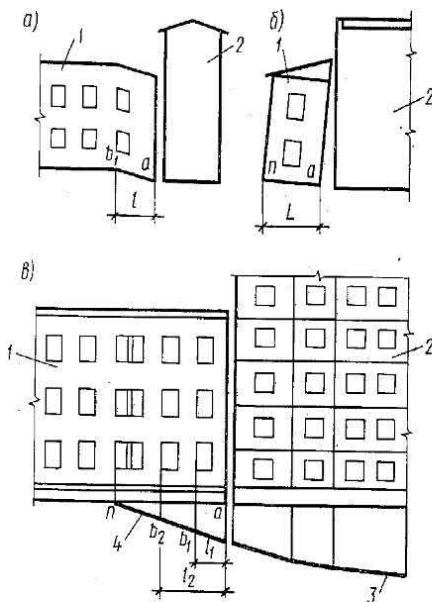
Схема к определению крена здания и перекопа его конструкций в результате развития дополнительной осадки:
